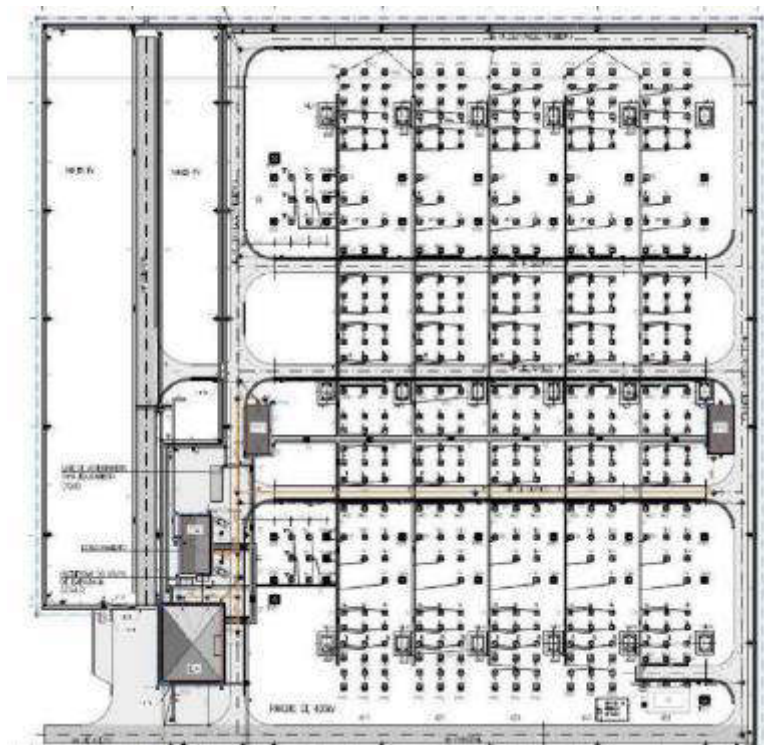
Layout final do Posto de Corte de Vilarouco, incluindo a central fotovoltaica para autoconsumo
